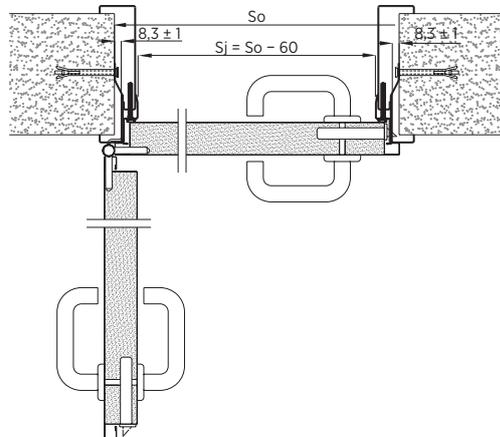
Montage der einflügeligen Türen mit Umfassungszarge - Horizontalschnitt
